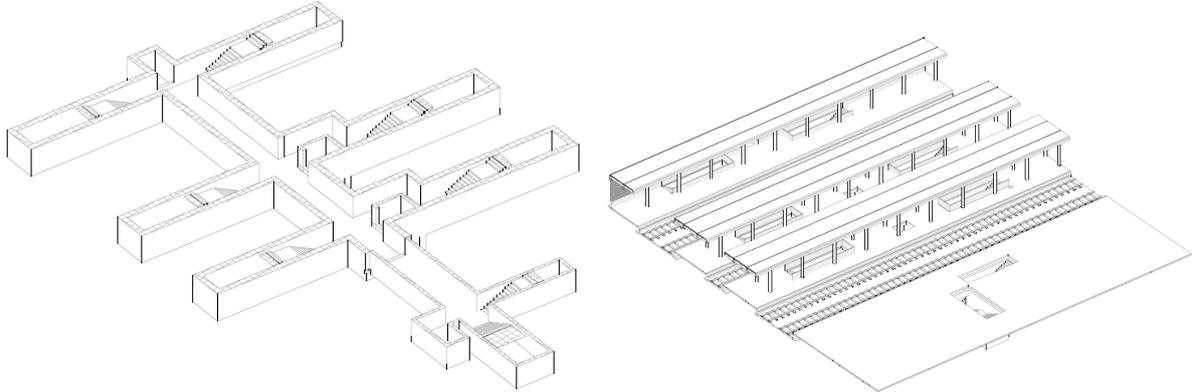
Prolungamento sottopasso di stazione SL01 - Spaccato assometrico e vista 3D
